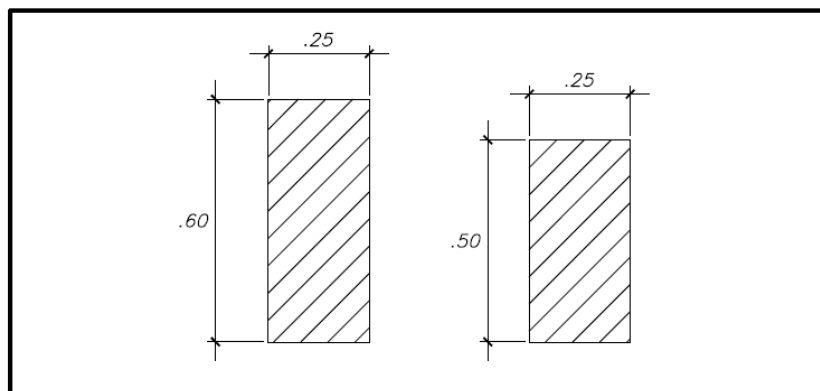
Columnas predimensionamiento eje 6 – C y para el resto
